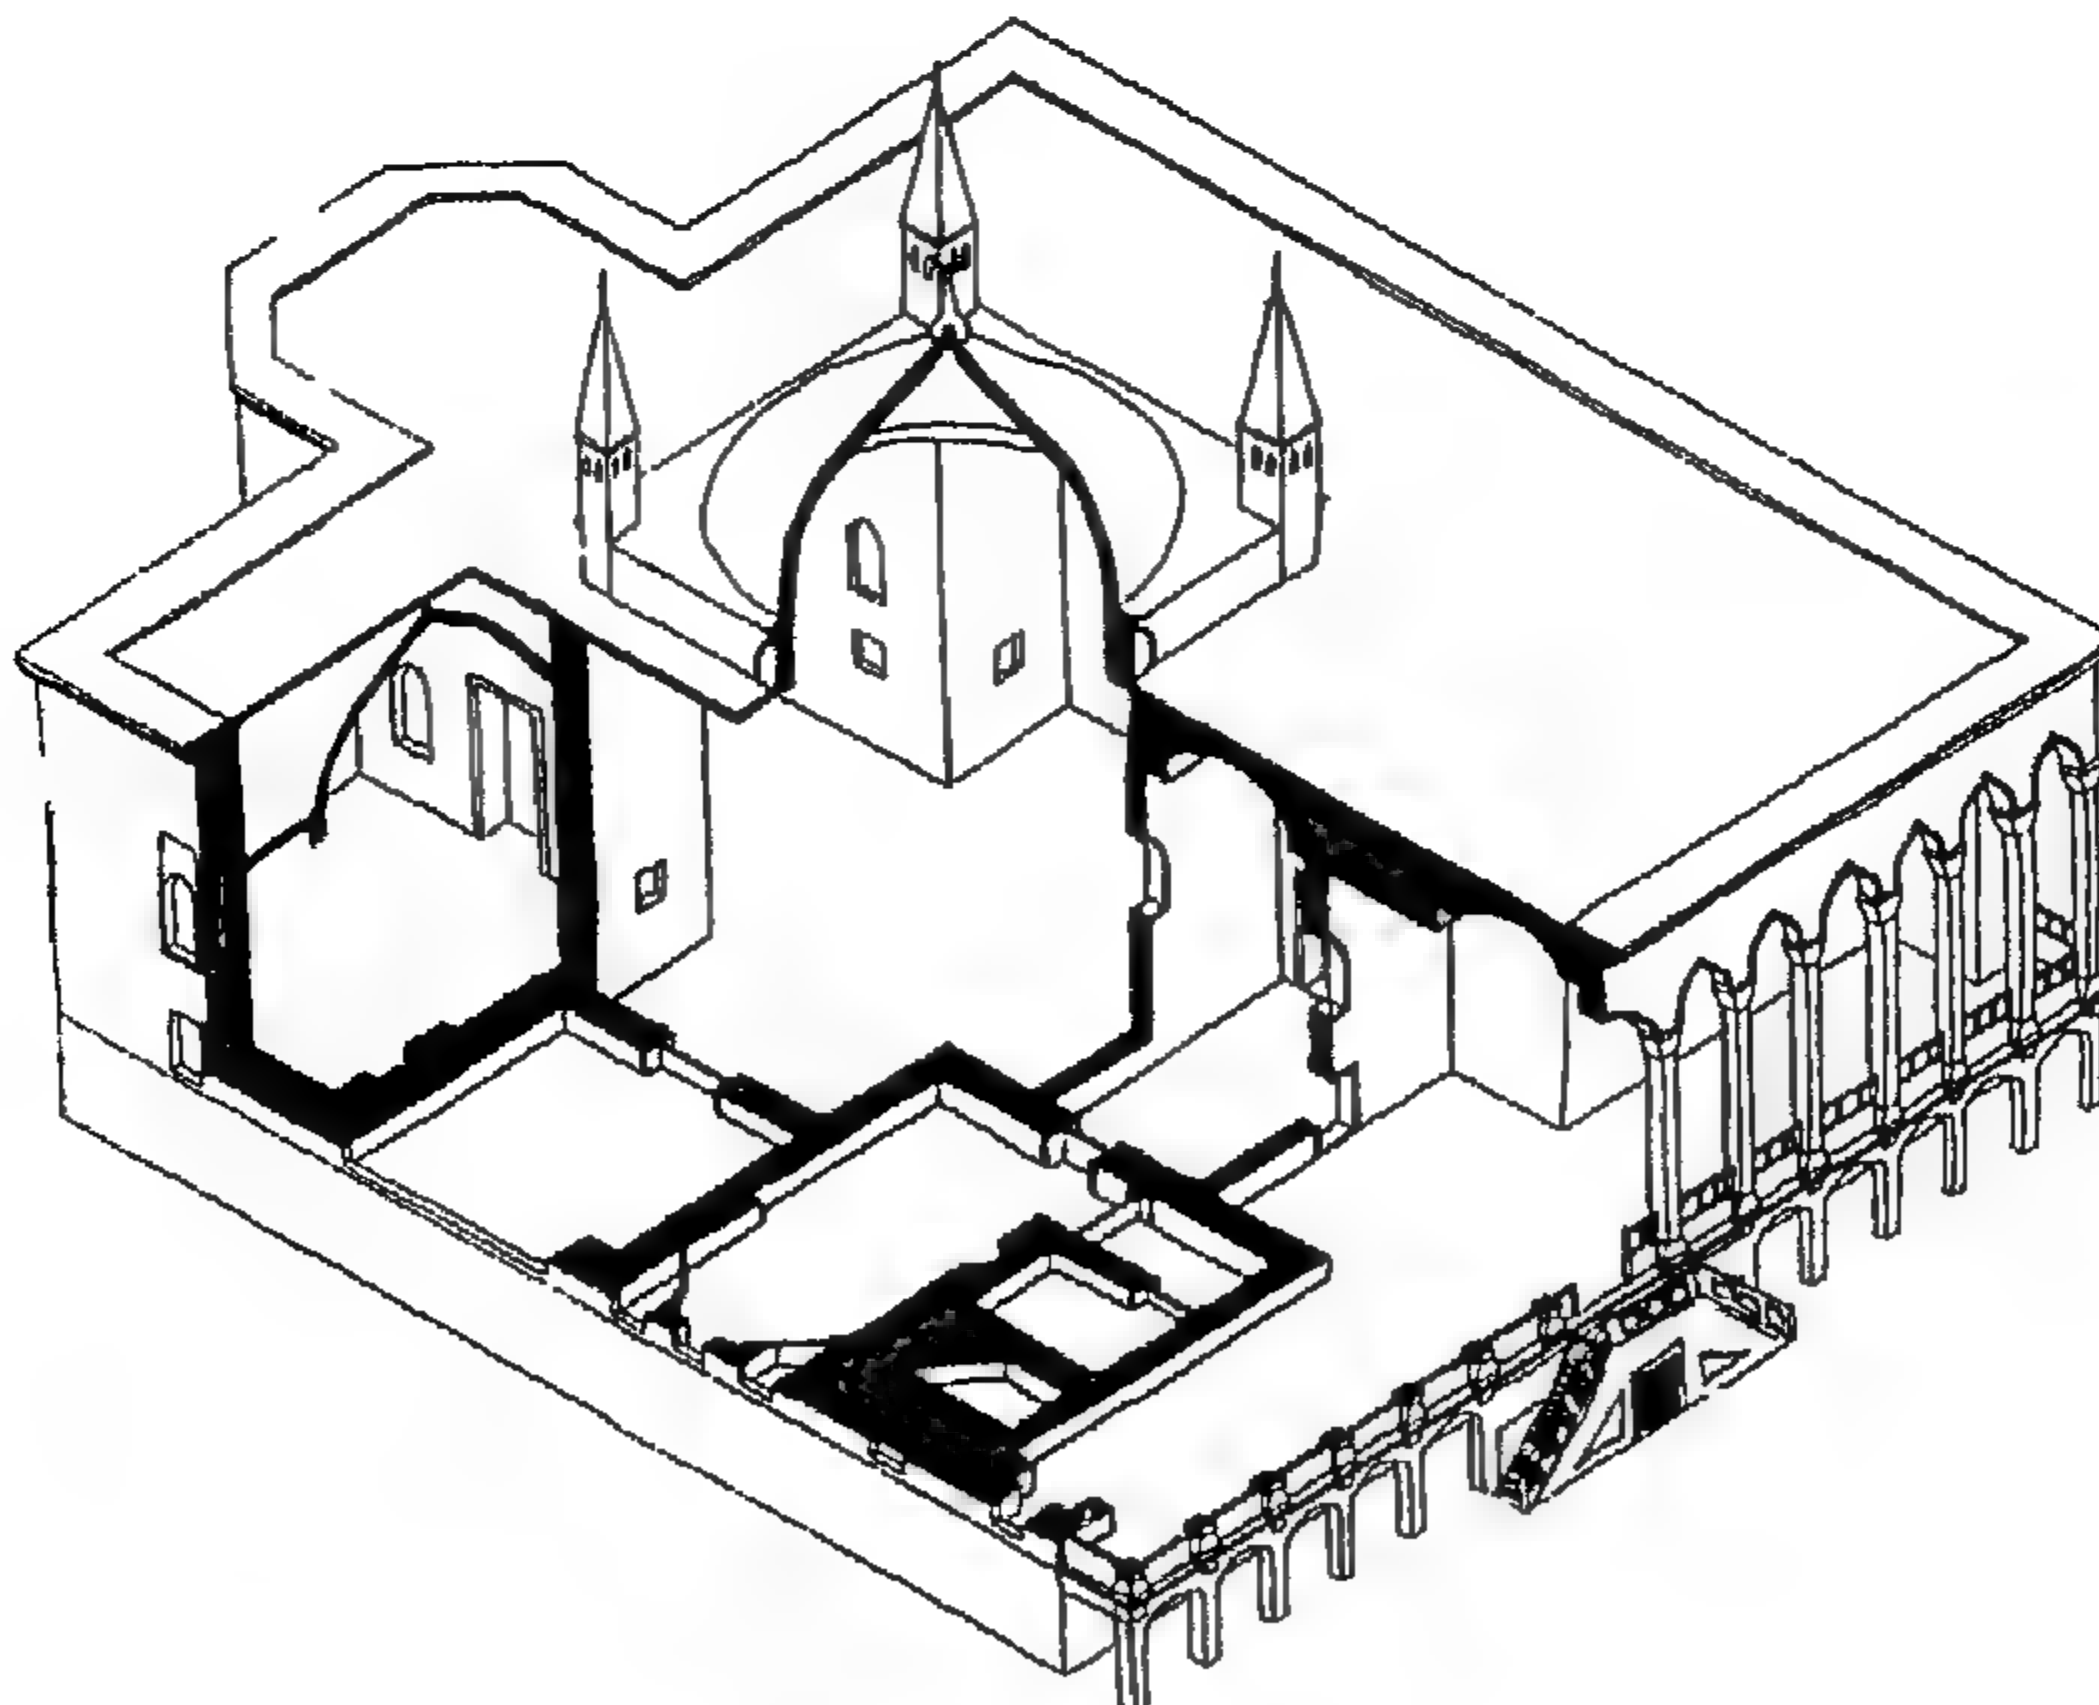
مسقط أفقى لقصر السلطان مسعود الثالث فى غزة (عن :اصلان ابا) .
